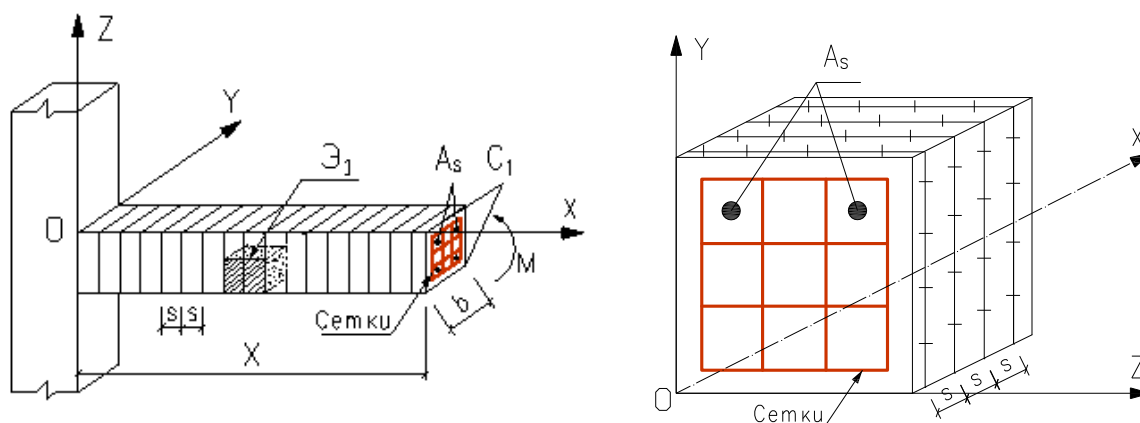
Фрагмент узла железобетонной рамы с характерным элементом Э1 (а) и схема характерного расчетного элемента с косвенной арматурой (б)
